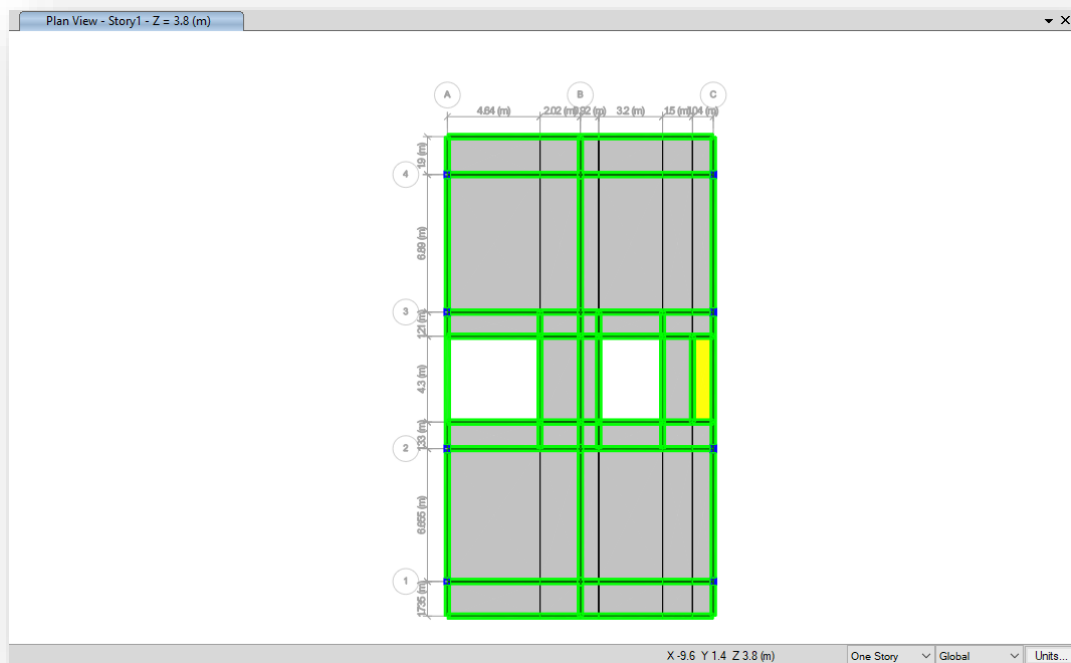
Vista planta bajaFigura 17 Planta h = Piso 3.8m
